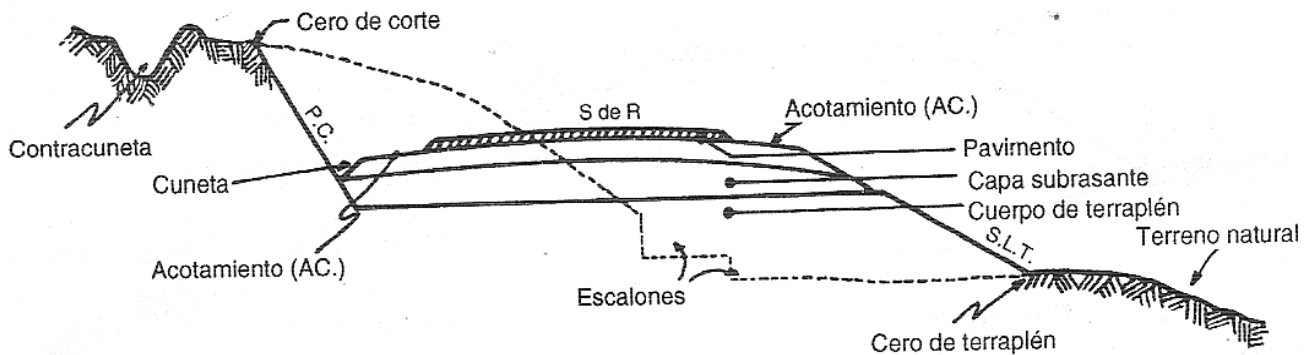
Sección transversal típica mixta o en balcón para caminos de dos carriles.
